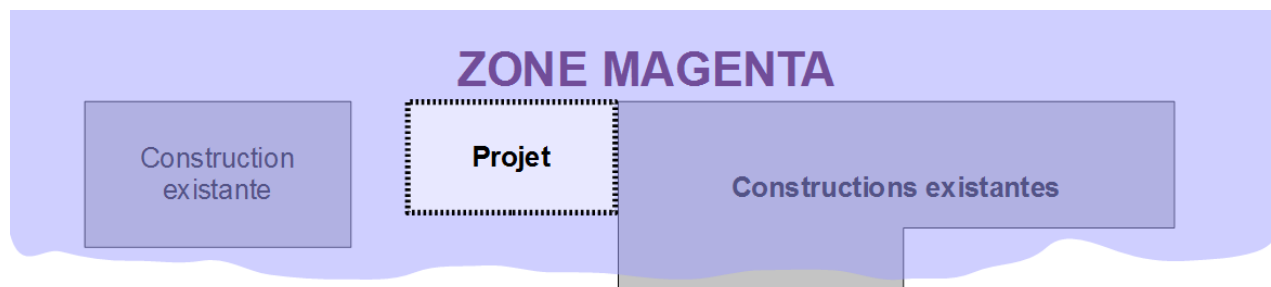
Construction s'inscrivant dans un front bâti et située dans l'alignement entre deux constructions avec un espacement
